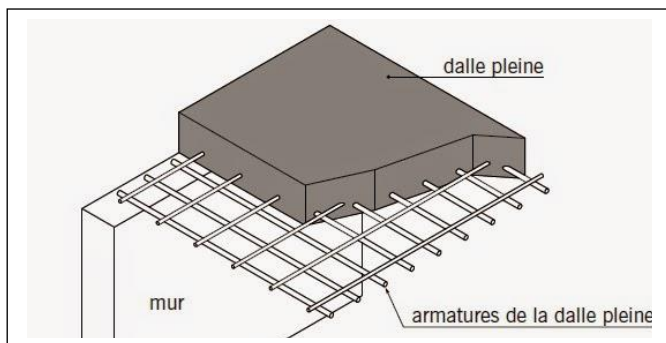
Modèle de plancher en Béton armé<sup>102</sup>.
